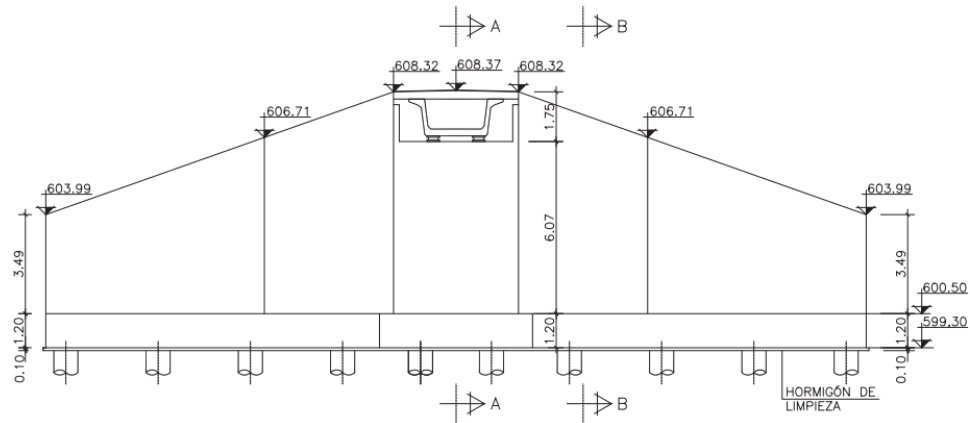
Alzado estribo 1 pasarela peatonal en la vía verde
